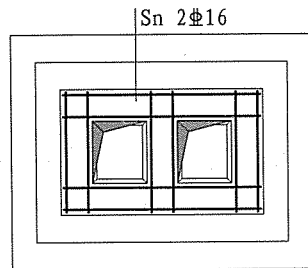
双杯口独立基础顶部焊接钢筋网示意
